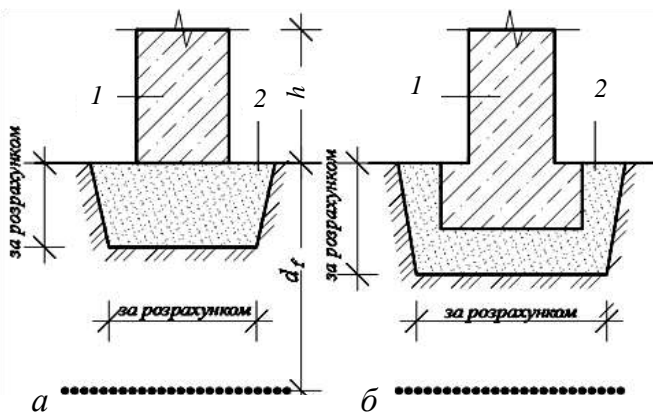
Стрічкові фундаменти малоповерхових безпідвальних будинків на протиздимальних подушках: *a* – фундамент-цоколь; *б* – фундамент з підширенням; 1 – монолітний залізобетонний фундамент; 2 – подушка протиздимальна; d_f – глибина промерзання; h – висота фундаменту
